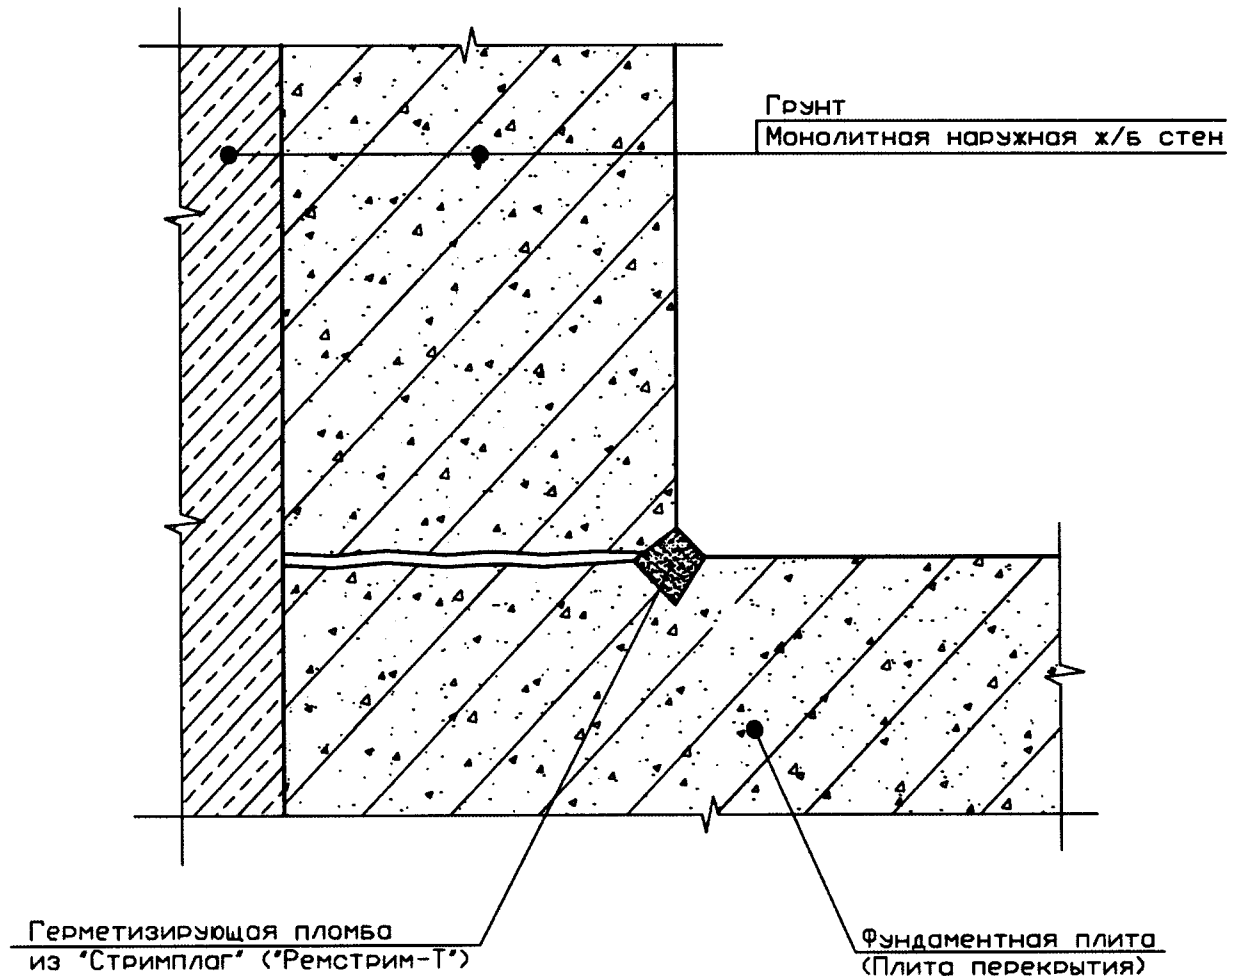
Герметизация конструктивных швов примыкания: «фундаментная плита-наружная стена», «плита перекрытия-наружная стена». Устройство герметизирующей пломбы
